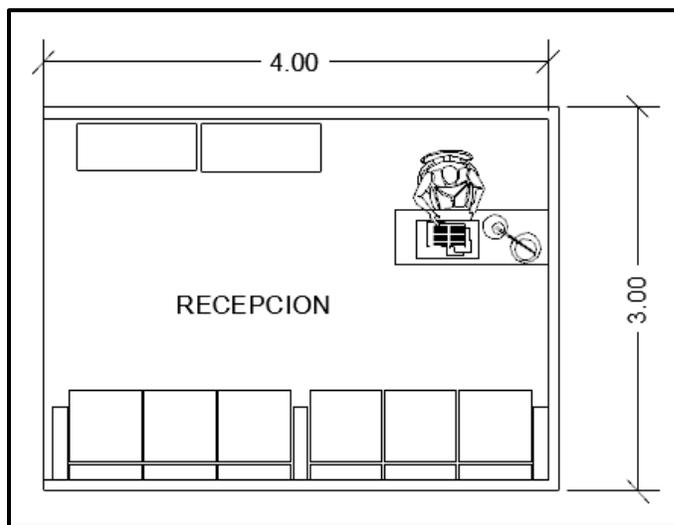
propuesta distribución en planta recepción y administración SIN ESCALA
